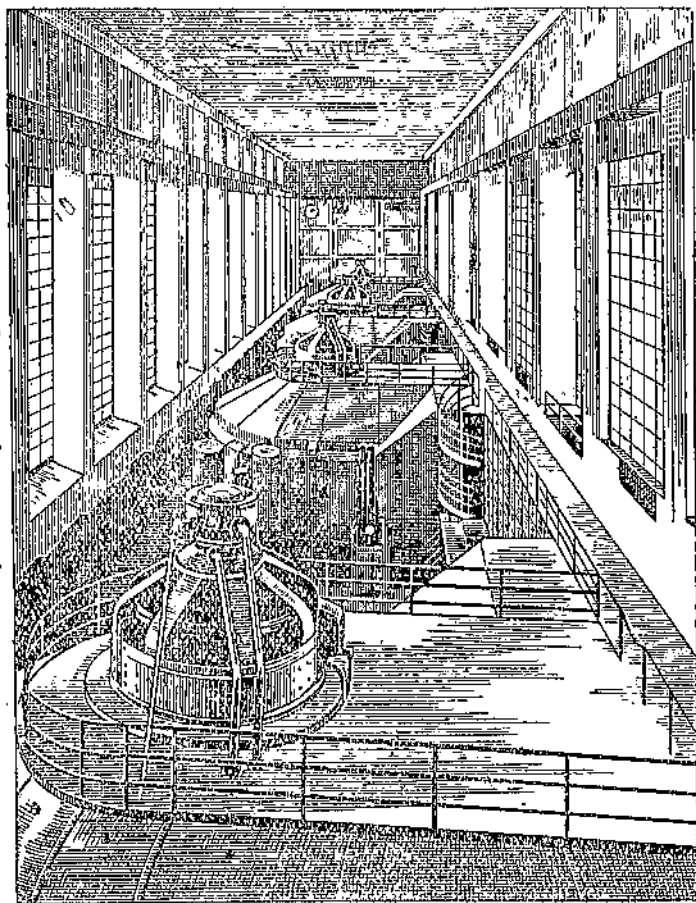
, б. Машинное здание гидроустановки, изображенной на фиг. 76. Горизонтальные разрезы.
